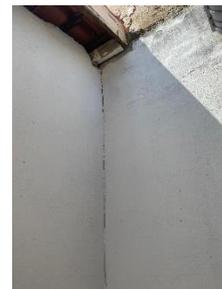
BANHEIRO EXTERNO; RACHADURA EXISTENTE ENTRE AS PAREDES.
